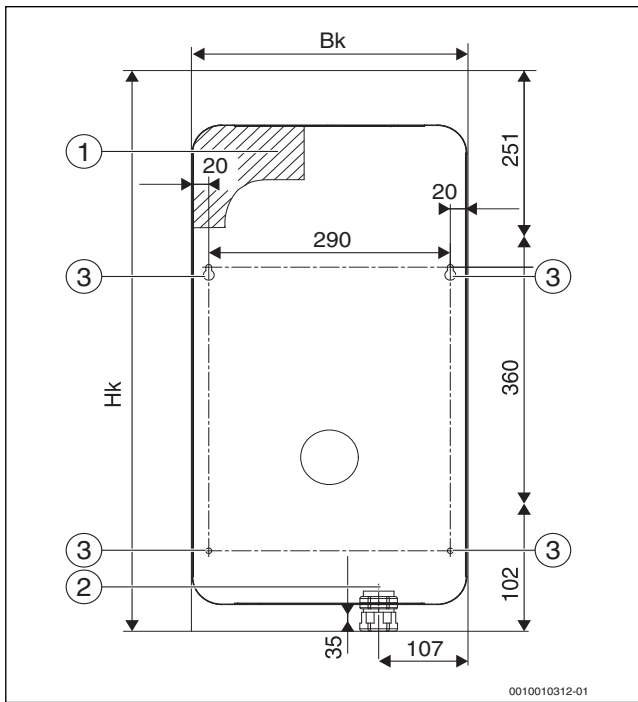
Abmessungen der Bohrungen für das Befestigen des Heizkessels an der Wand und für das Versorgungskabel beim Heizkessel Tronic Heat 3000 4-12 kW
